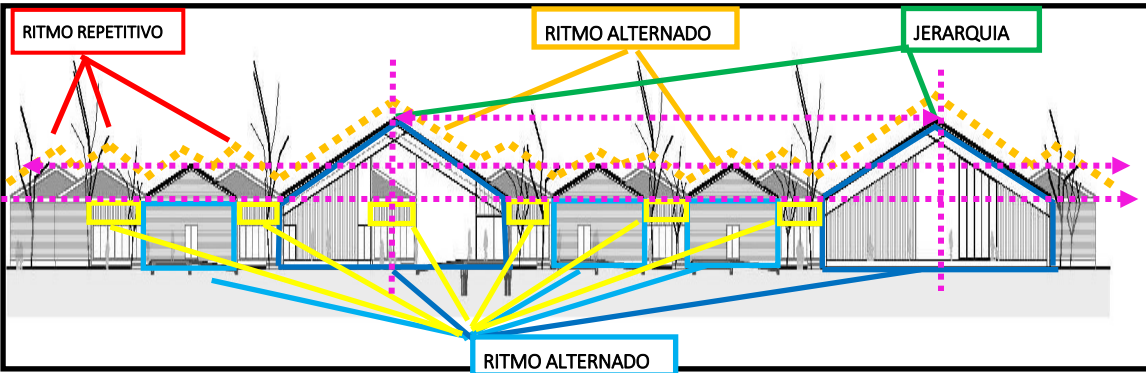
ALZADO DE FACHADA POSTERIOR- HOSPITAL PUYO
